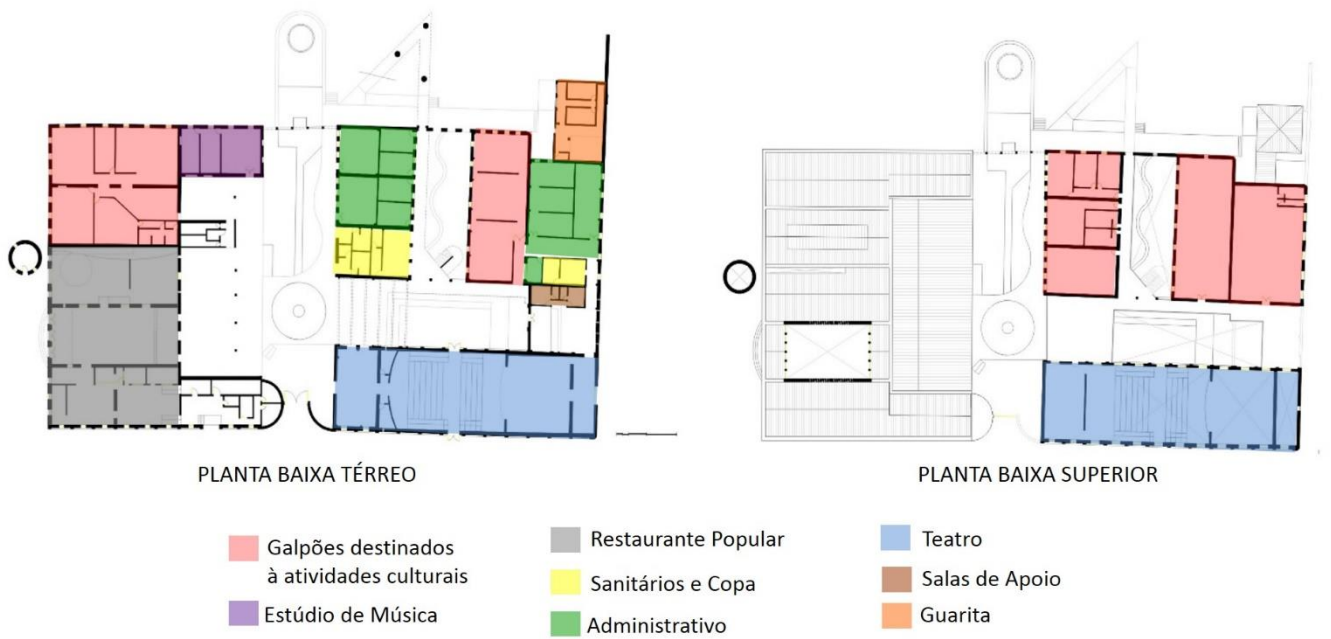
Plantas Baixas dos Pavimentos do ECOA. Sobral/Ce.
